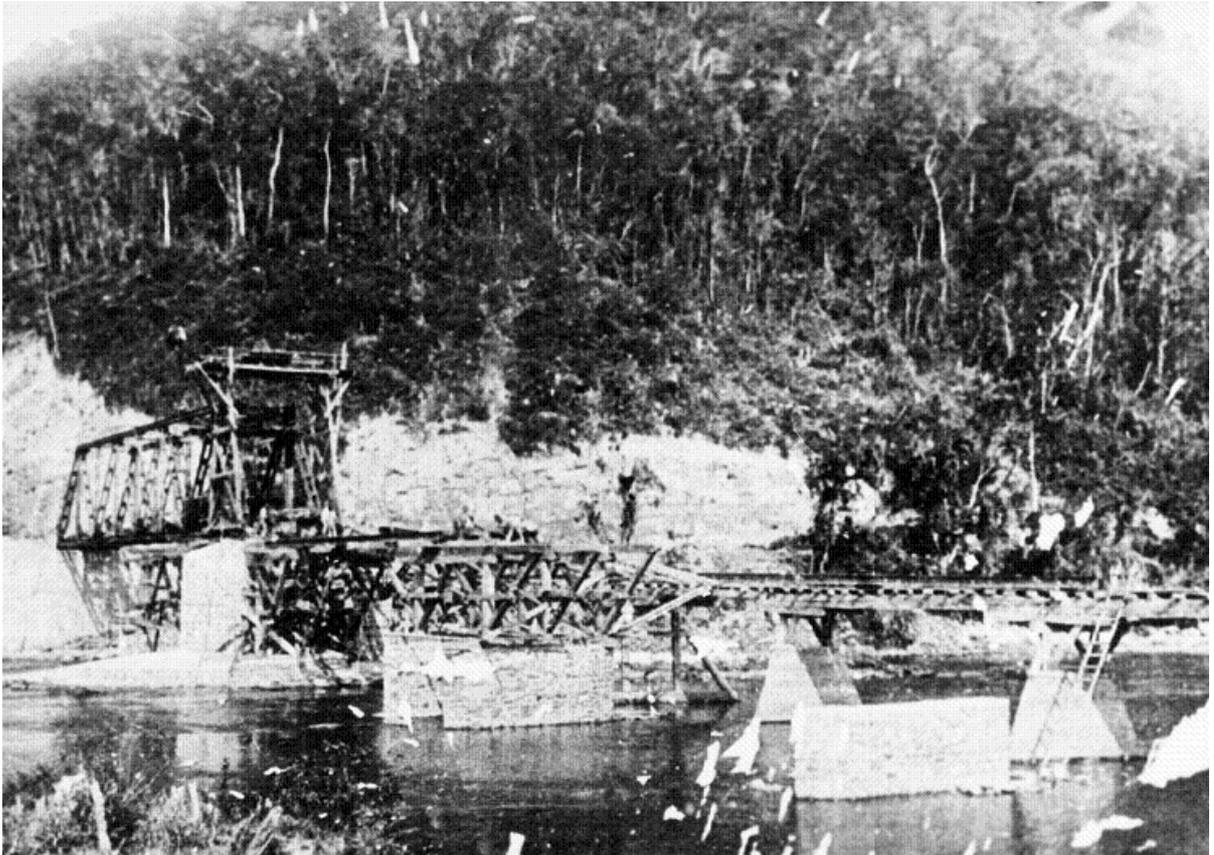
Construção da ponte de ferro sobre o rio Itajaí-Açu em Hammonia, em 1909. Mede 102 metros e foi obra da empresa alemã que construiu os primeiros 70 quilômetros da EFSC
